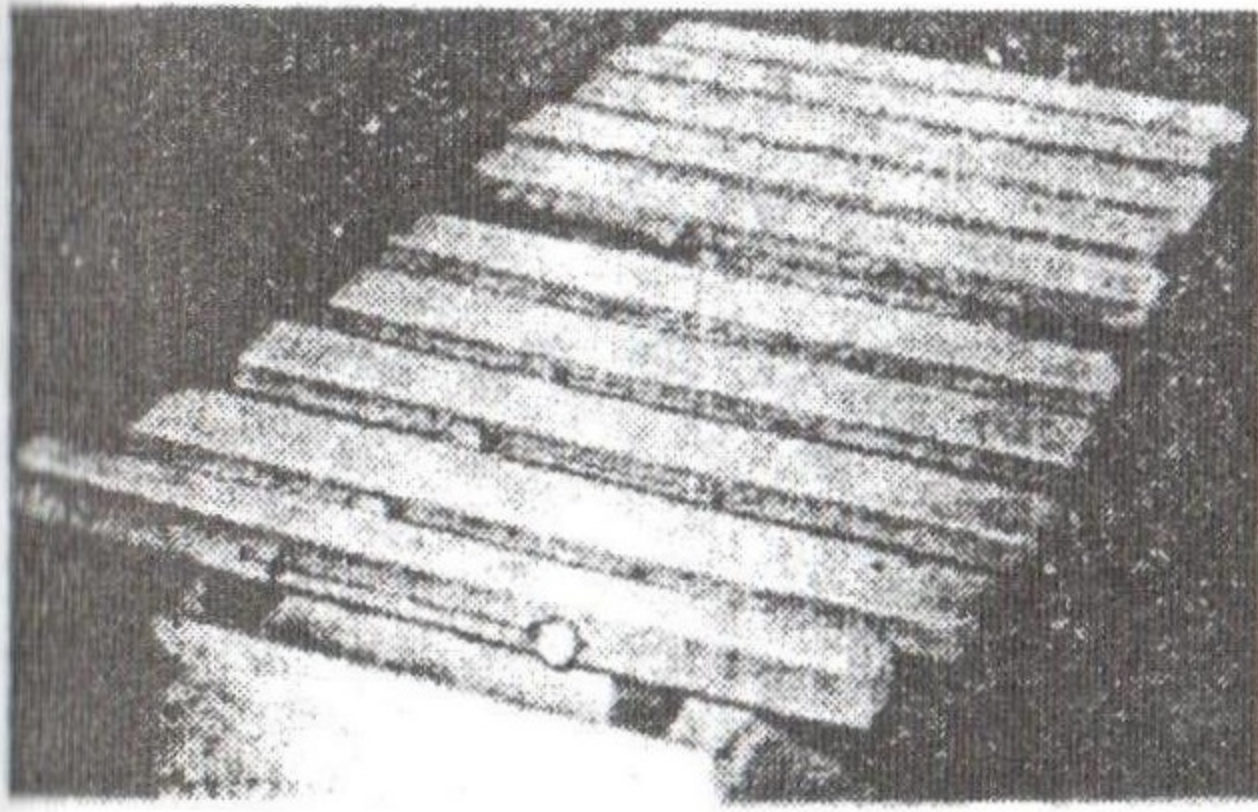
Испытания бетонных и железобетонных плит на усадку
